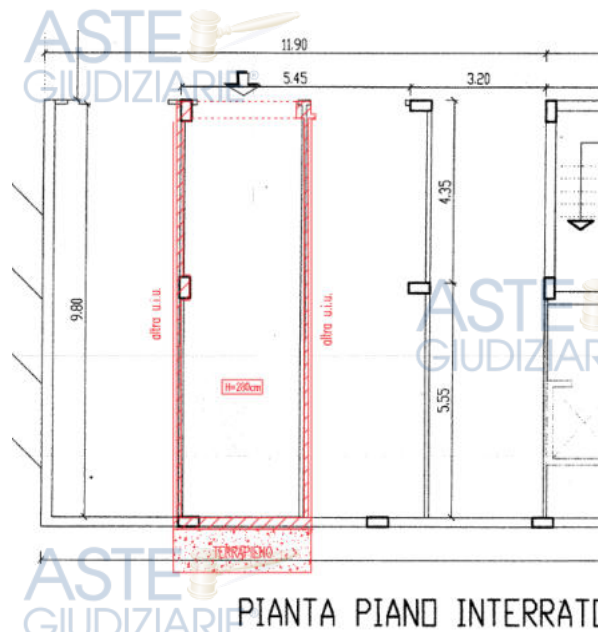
sovrapposizione planimetria di progetto e di stato dei luoghi.
